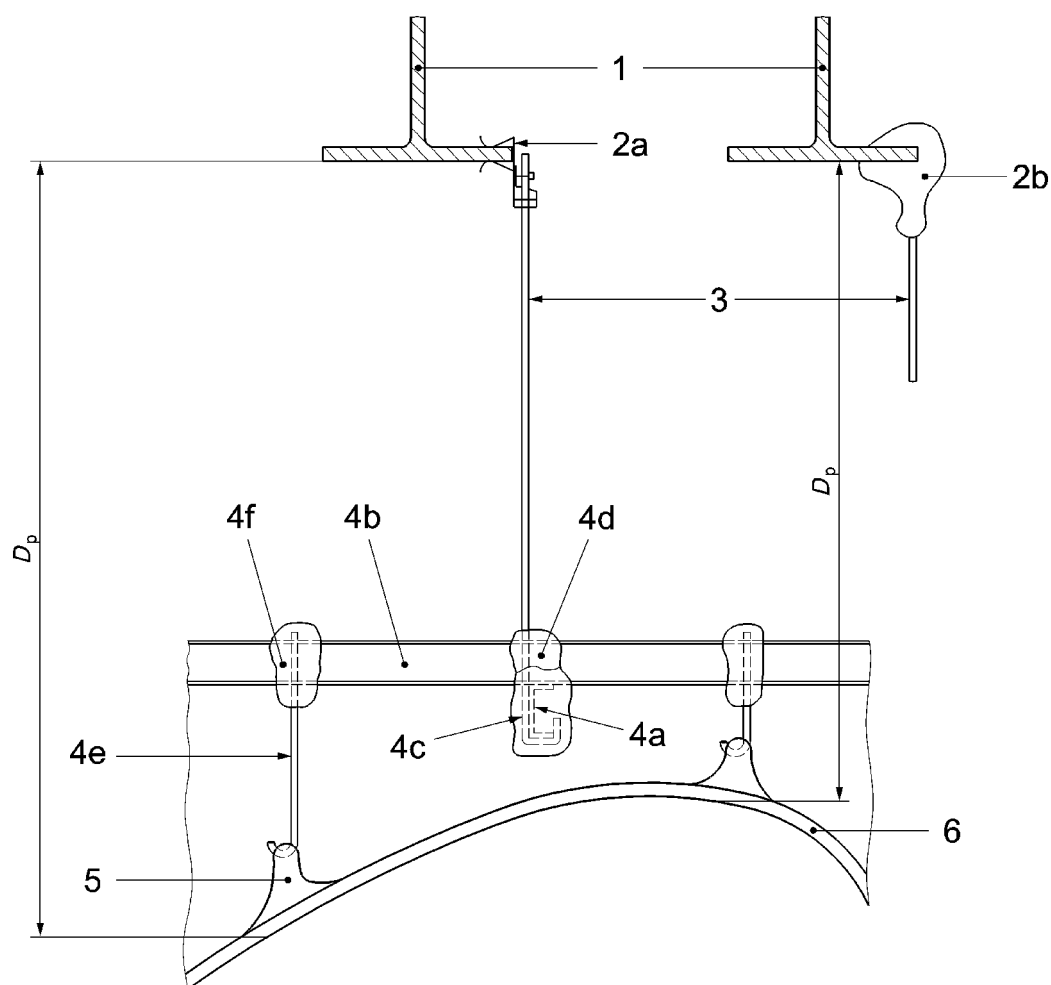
Exemple de mise en oeuvre à faible ou moyen écartement (D_p) d'un plafond suspendu en staff sous dalle en béton armé
